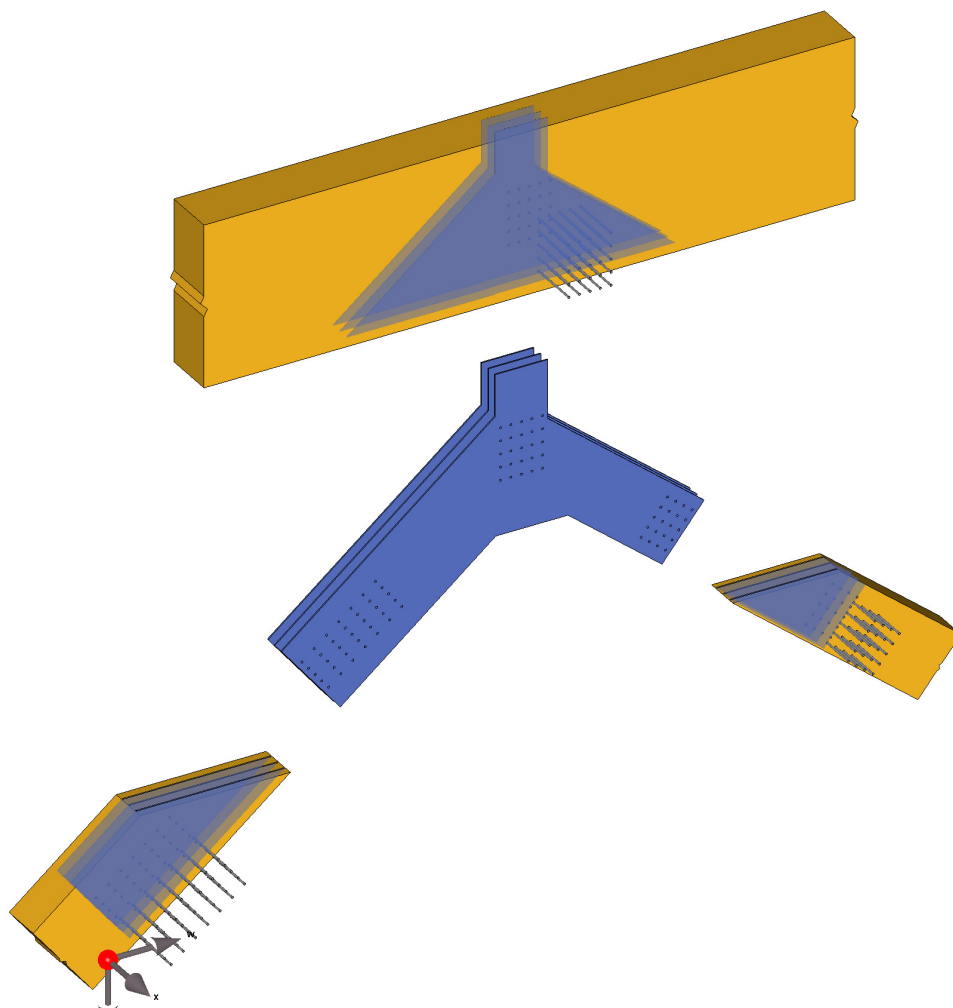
Explosionszeichnung des Anschlusses für Fachwerk FC1
